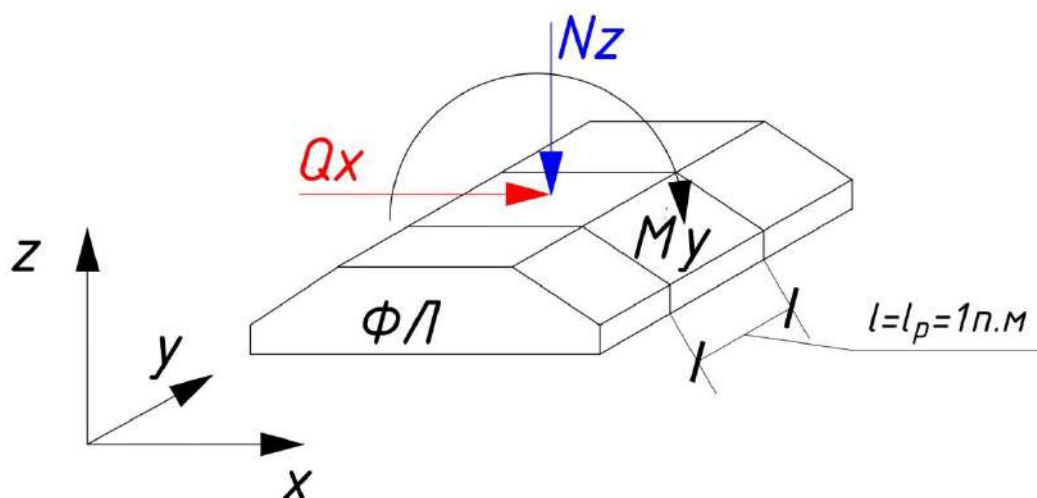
Расчетная схема сборного фундамента в осях 2К.
